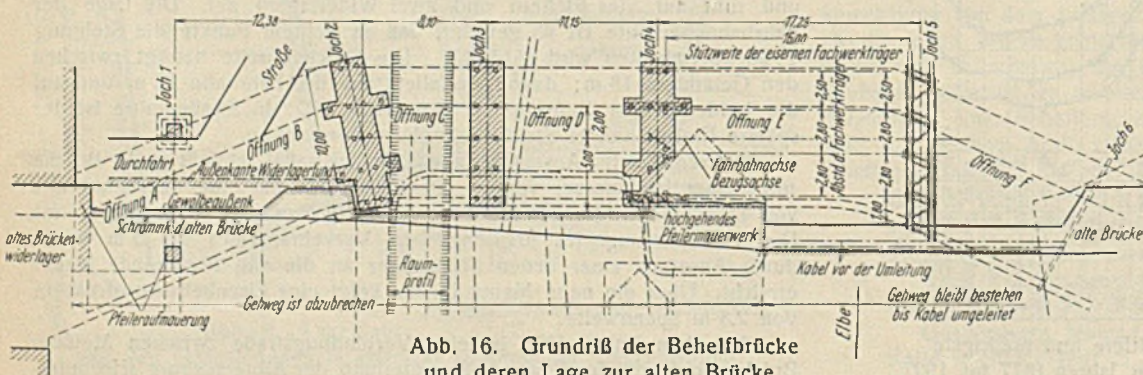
Grundriß der Behelfsbrücke und deren Lage zur alten Brücke.
